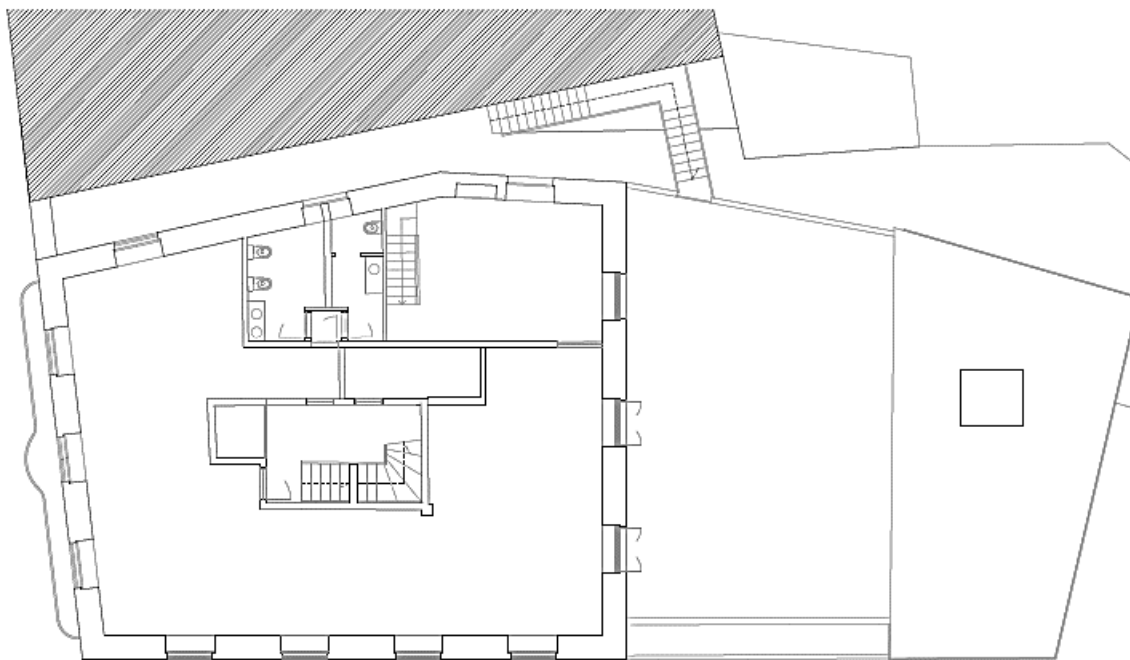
Planta 2 à cota do balcão – Esc. 1/200- Esc. 1/200 – Autora do projeto
